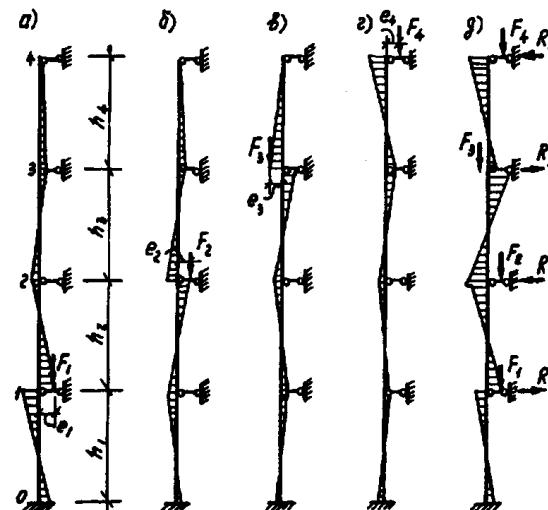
Расчетная схема колонн к определению изгибающих моментов, действующих перпендикулярно к плоскости поперечной рамы: а, б, в, г — от усилий, приложенных на 1...4 этажах; д — суммарная эпюра моментов
